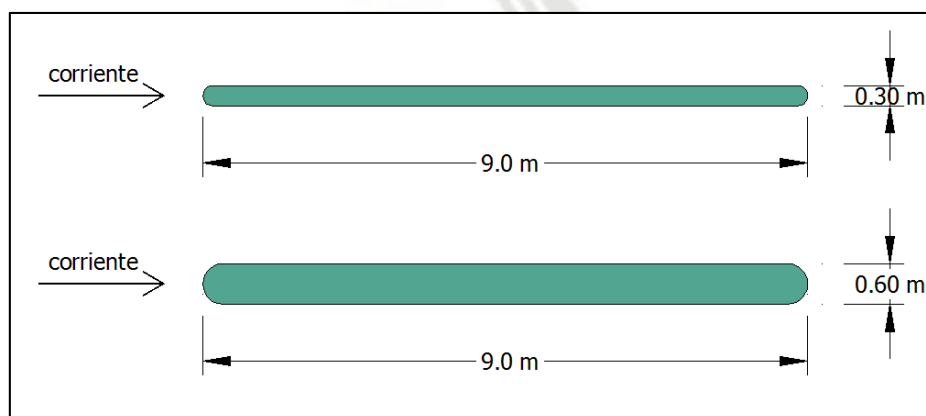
8, Sección de Pila puente “Aguas Verdes”. ^{PA}
